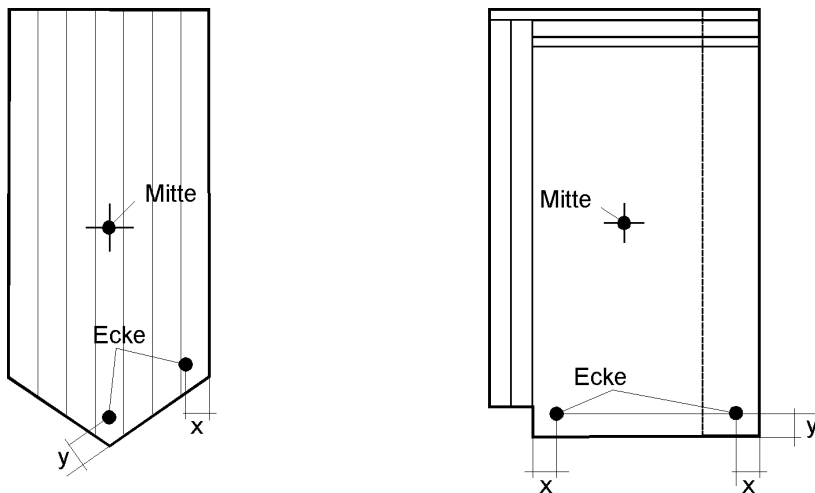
Beschussorte im Grundriss für den Tondachziegel und Betondachsteine ohne Falz (links) und den Falzziegel (rechts),  $x = y$ : 1/5 Projektildurchmesser, Masse in Millimeter
